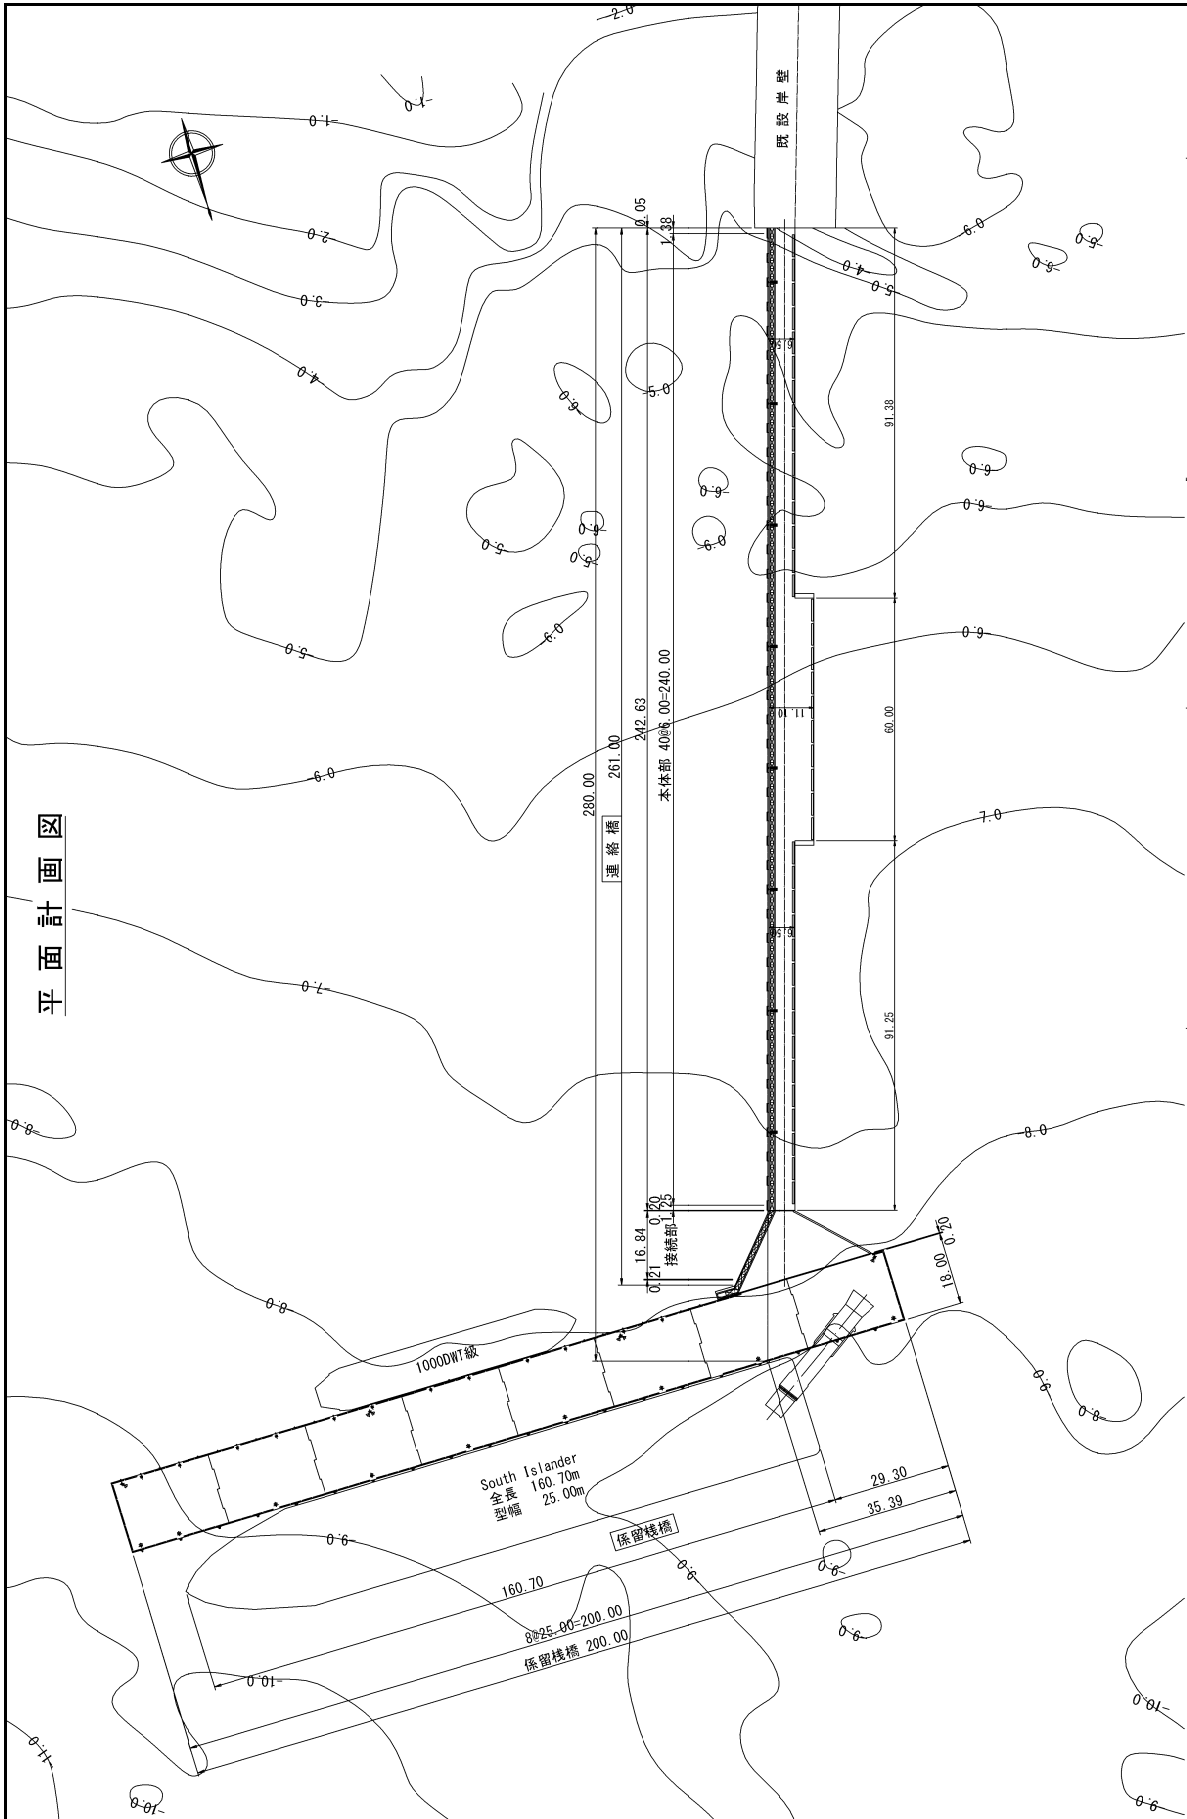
係留棧橋及び連絡橋の平面計画図
